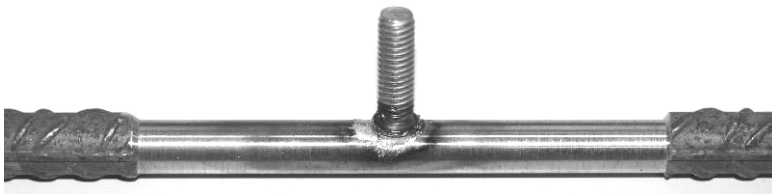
Detailaufnahme des aufgeschweißten Gewindebolzens.
